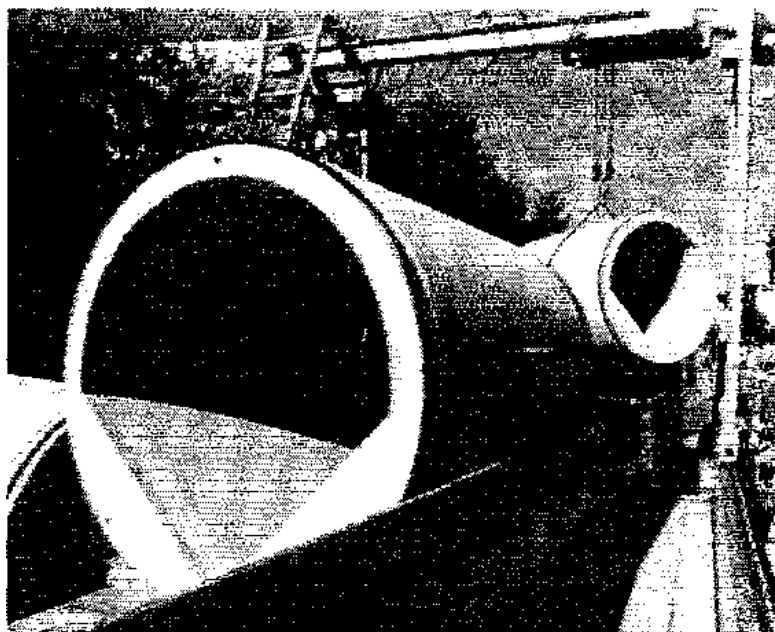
Железобетонная труба со специальным профилем для бестраншейной реновации
